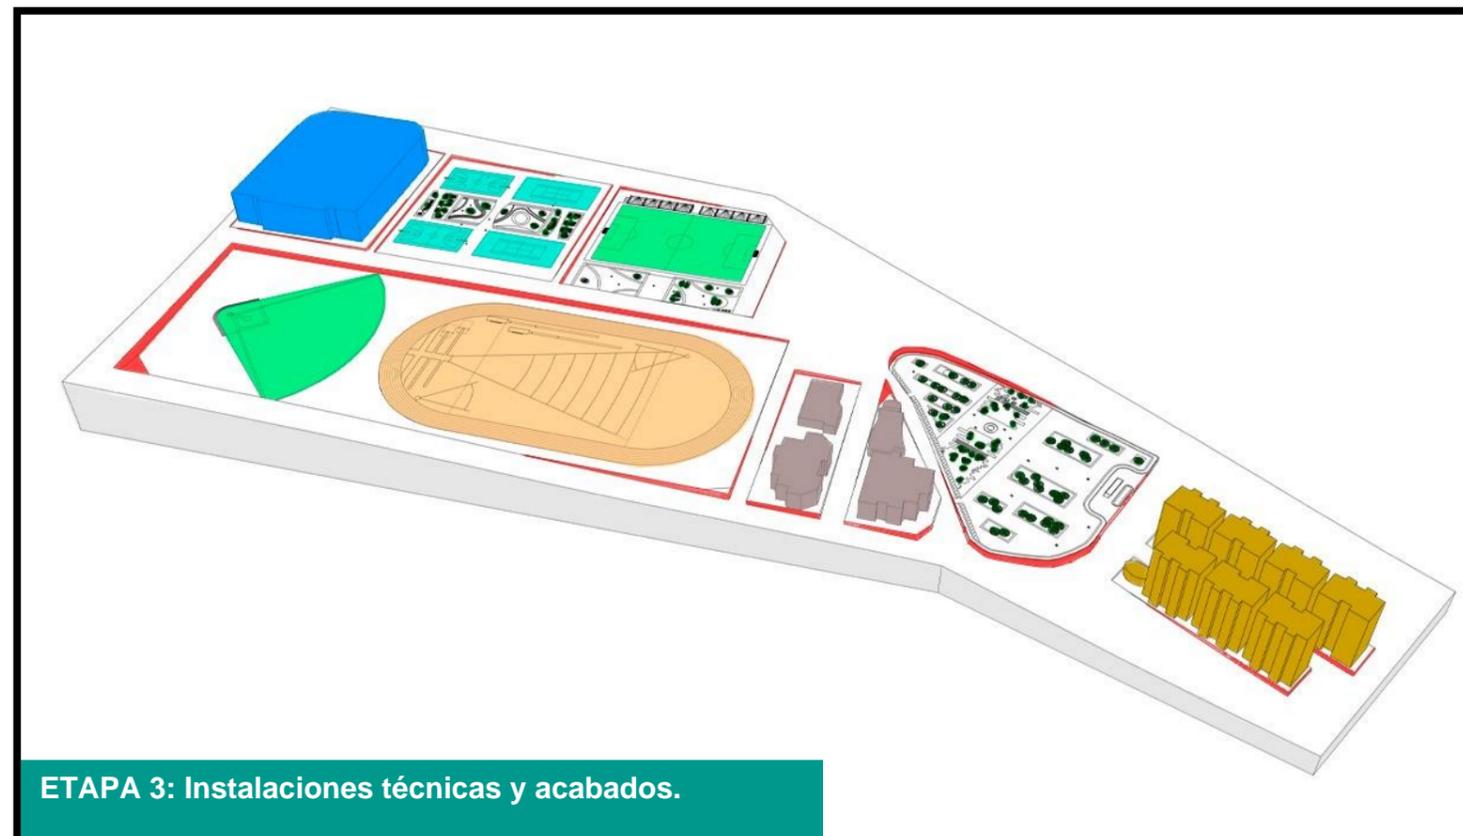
Plan Maestro de etapas, Fuente: autores
